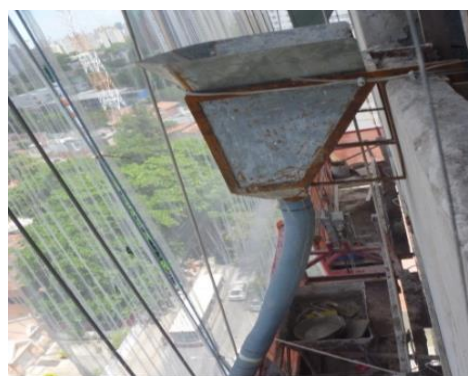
Transporte vertical de argamassa na obra piloto de revestimento.
